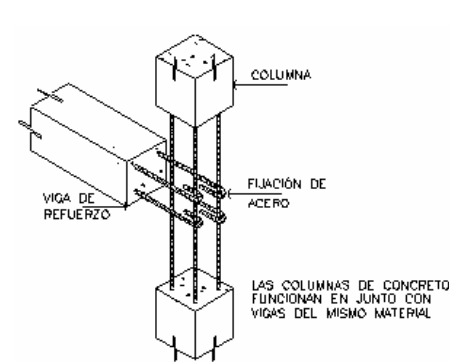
Columna de concreto reforzado. Fuente: elaboración propia
